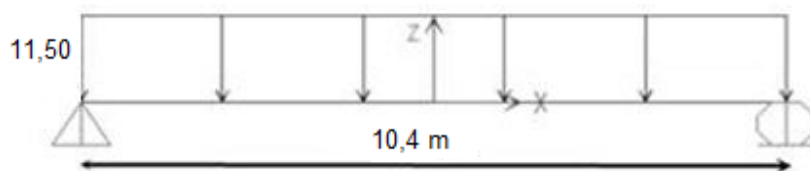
Modelo de cálculo da laje na zona do vão
